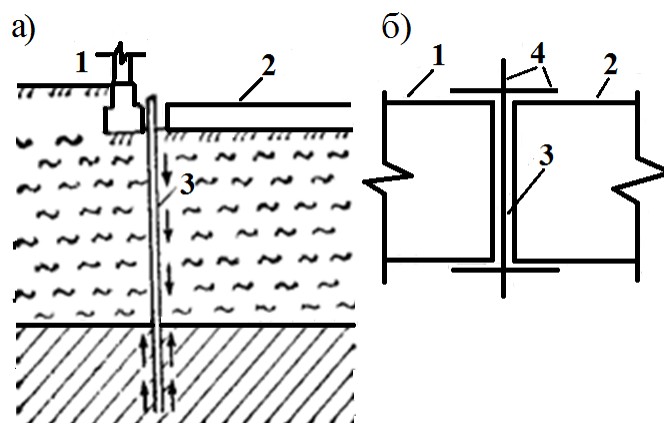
Воспроизведение приспособления разъединительной шпунтовой стенки а) - разрез; б) - план; 1 - существующее здание; 2- фундаментная плита; 3 - шпунтовая стенка; 4 - шпоры шпунтовой стенки
